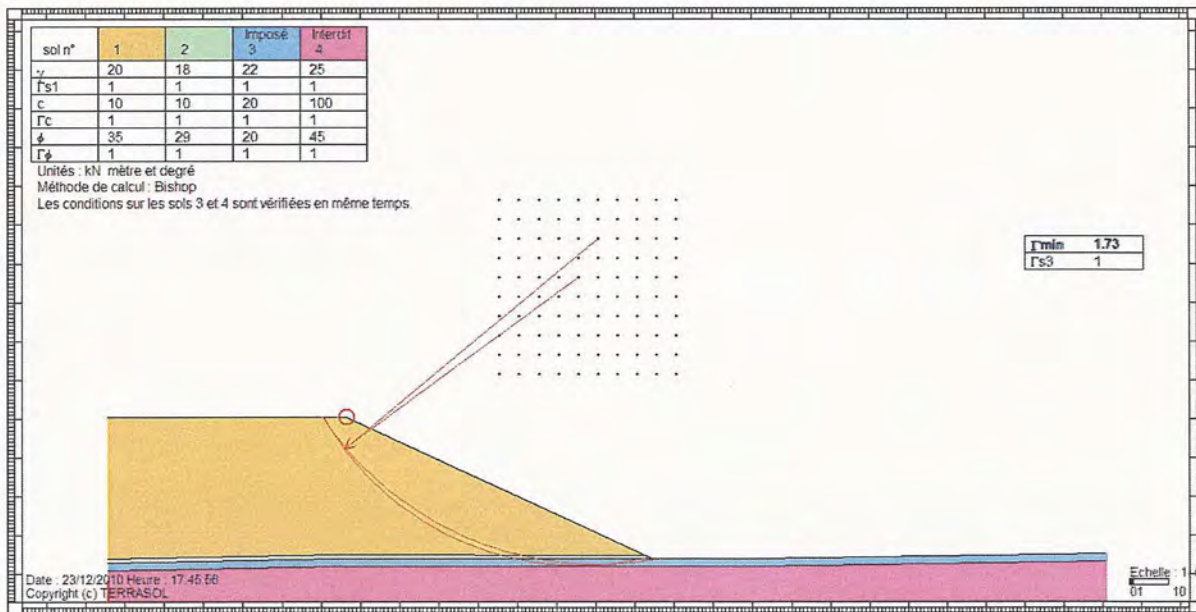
Coupe 5 : Stabilité vis-à-vis d'un glissement profond
